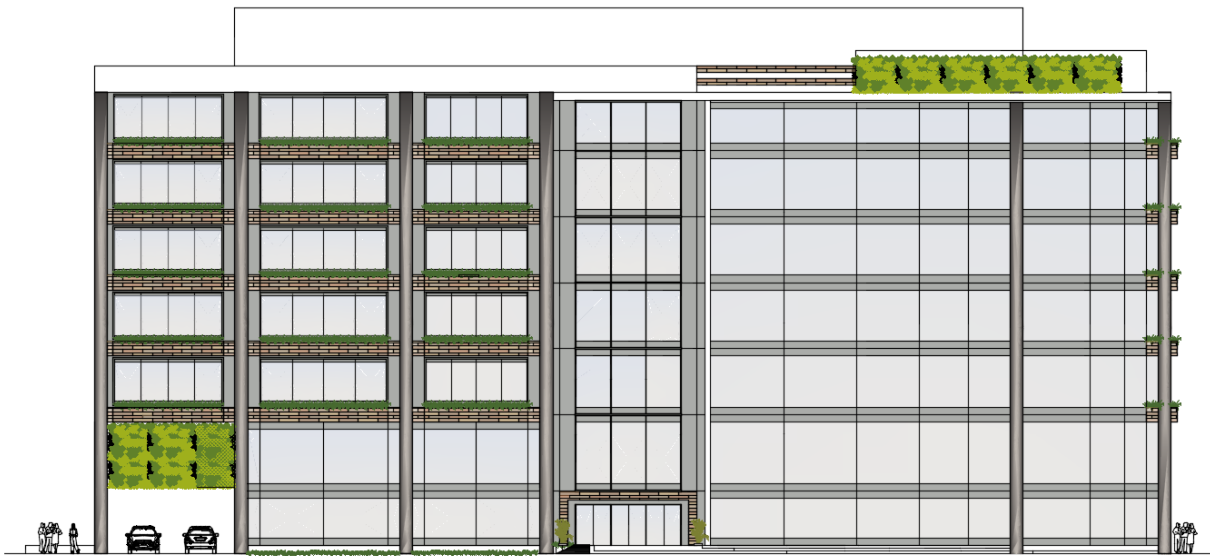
Fachada de ÁLMAR Centro Empresarial 1800 vista desde la calle Maranga - Fuente: Propia
